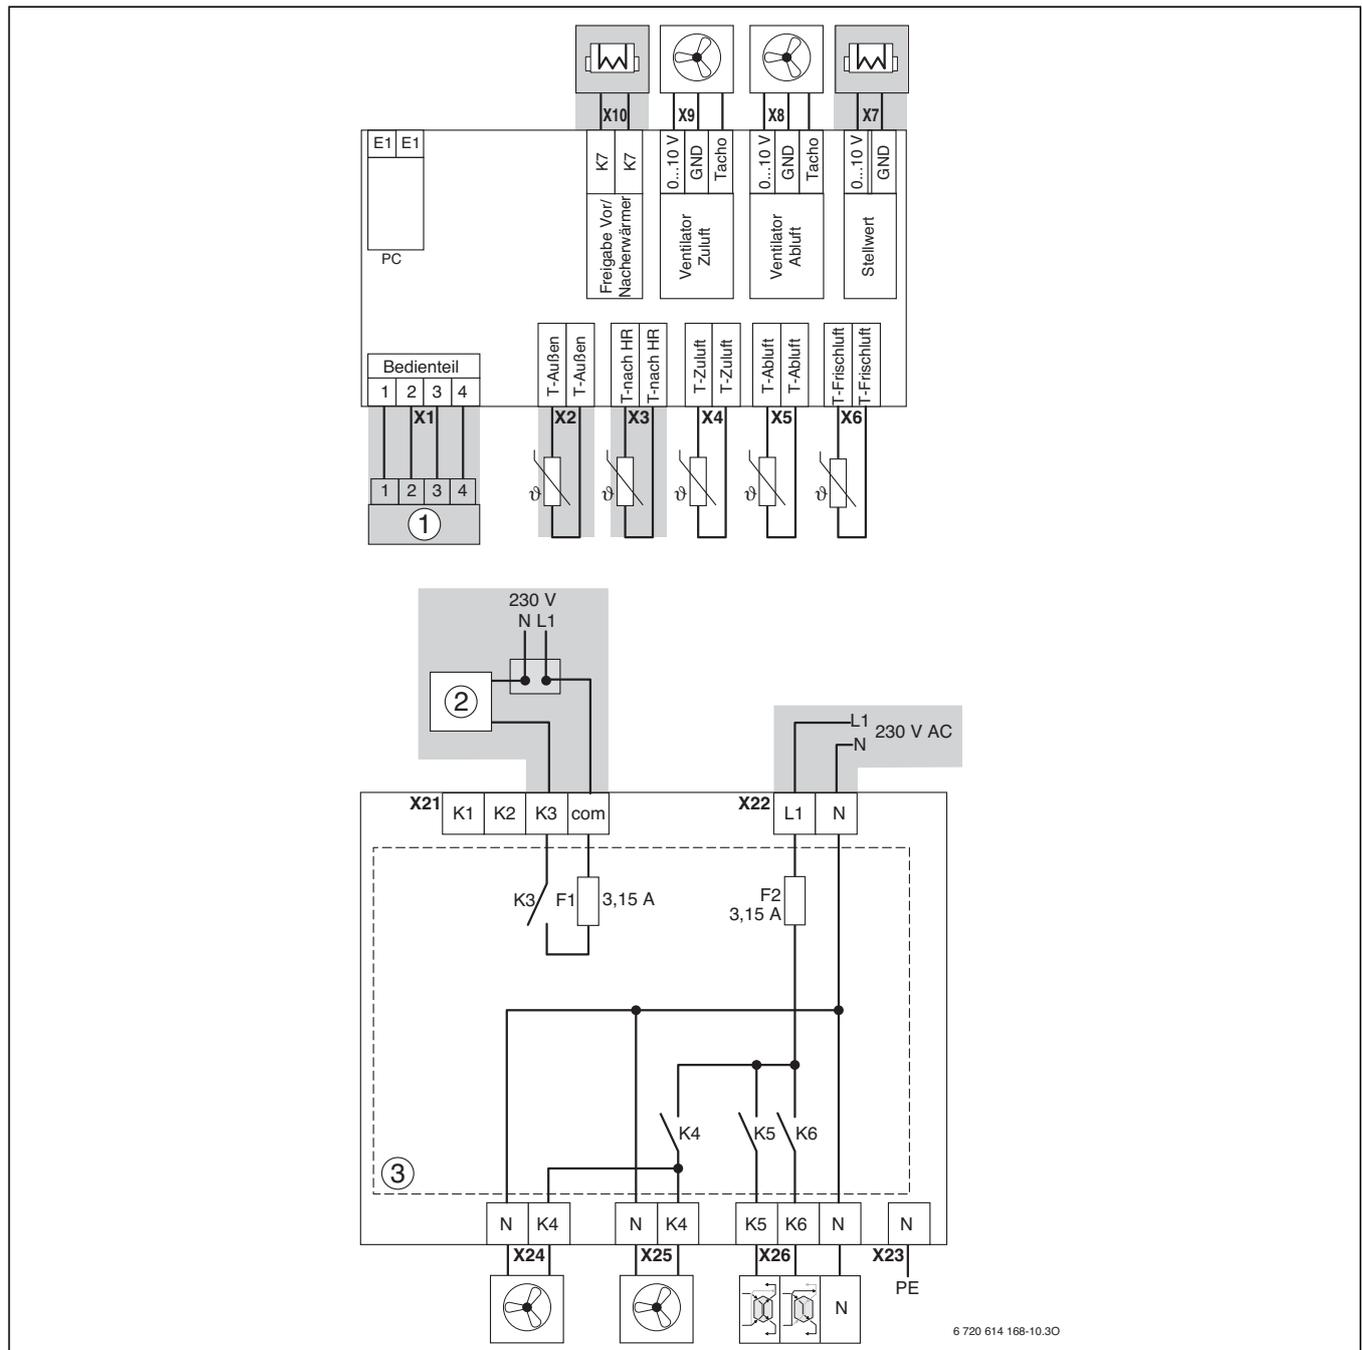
Anschlussplan (für Installation relevante Anschlüsse sind grau hinterlegt)
